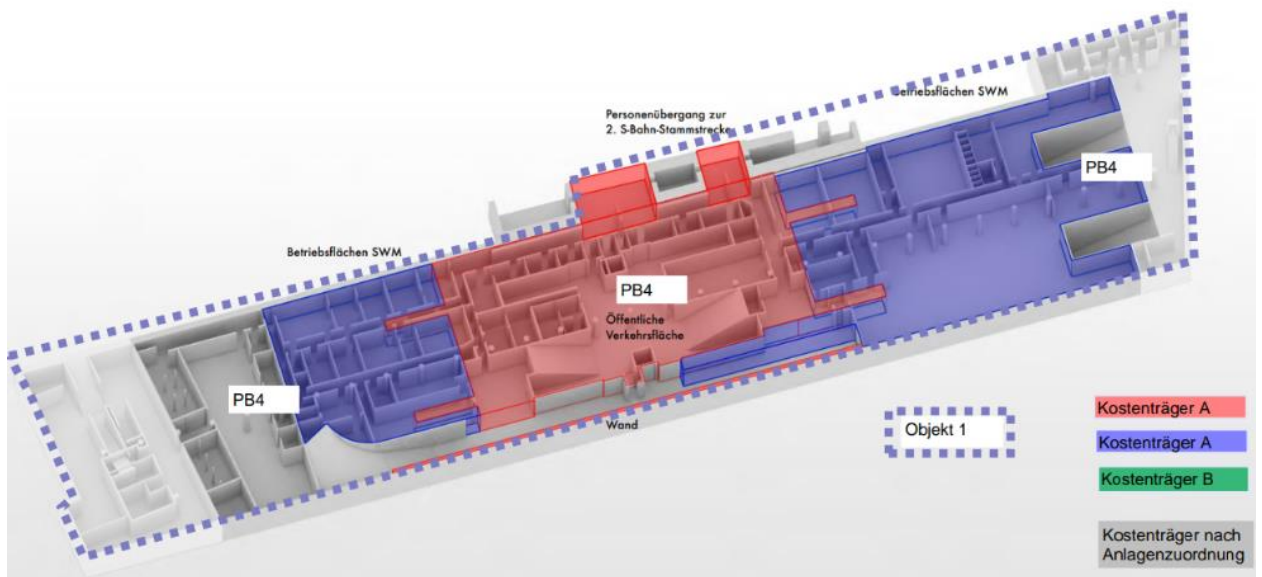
Einteilung Planungsbereiche – 3. Untergeschoss
